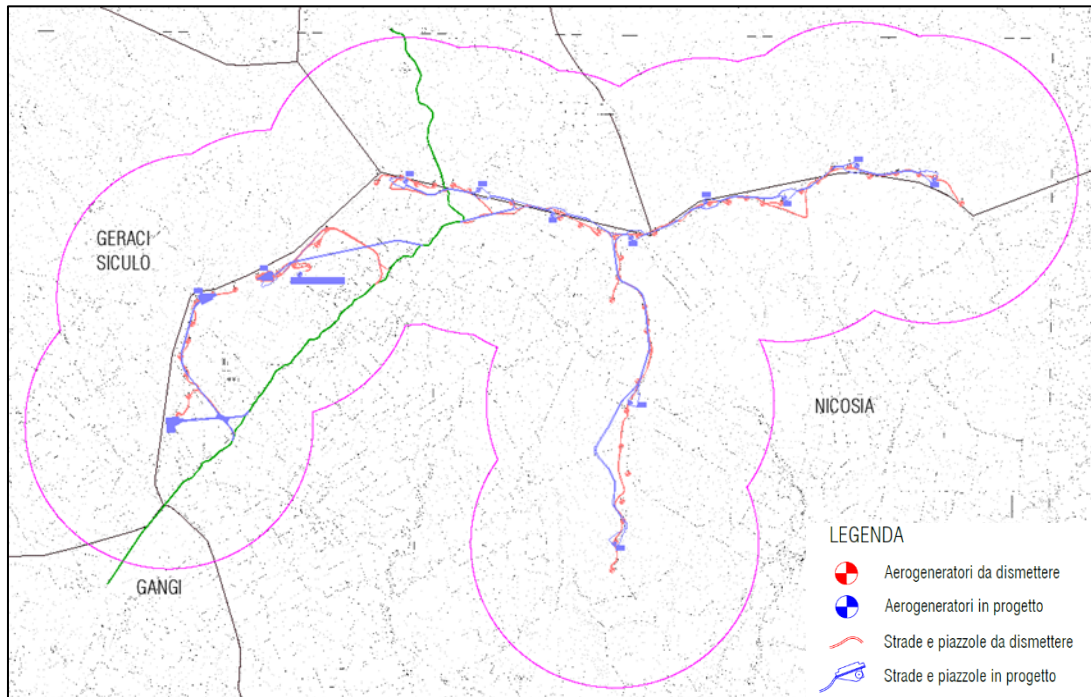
Layout di raffronto tra stato di fatto e stato di progetto
